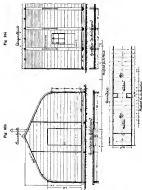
, 102 und 103. Fundament- und Außenputz-Details.
